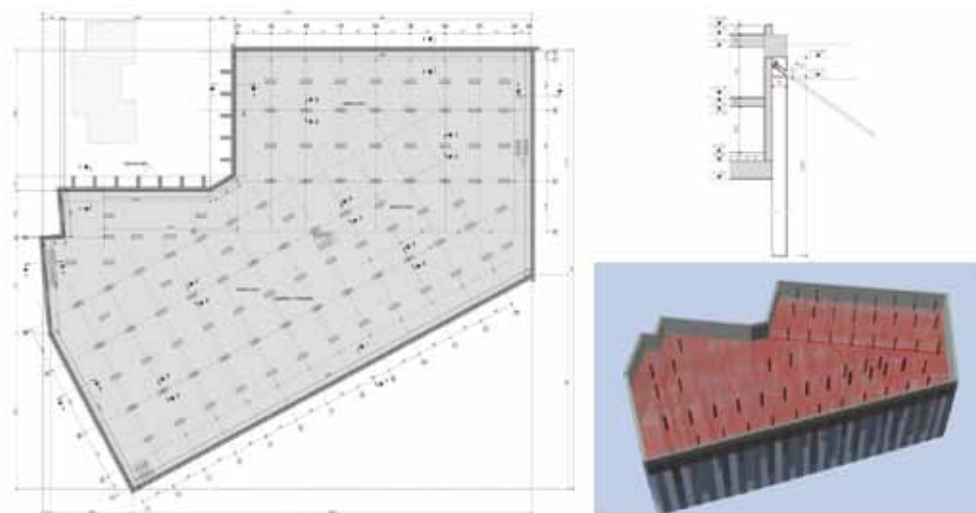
Pianta, sezione e vista tridimensionale del parcheggio interrato
